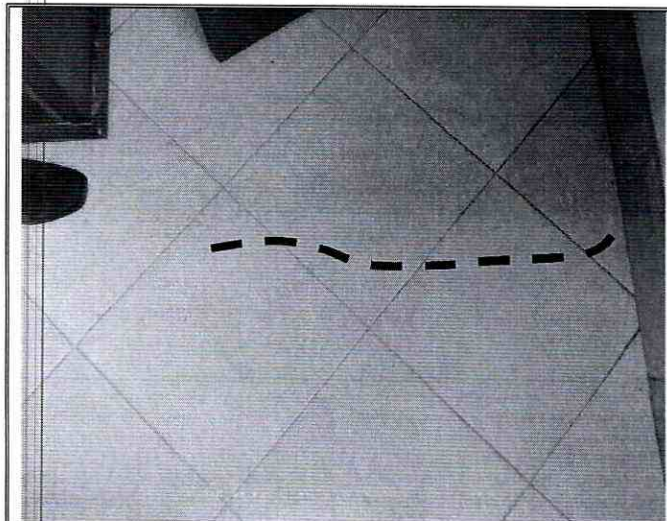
y 8. Presencia de fisuras y grietas en muros de la vivienda de la Carrera 77A No. 68A – 12.
